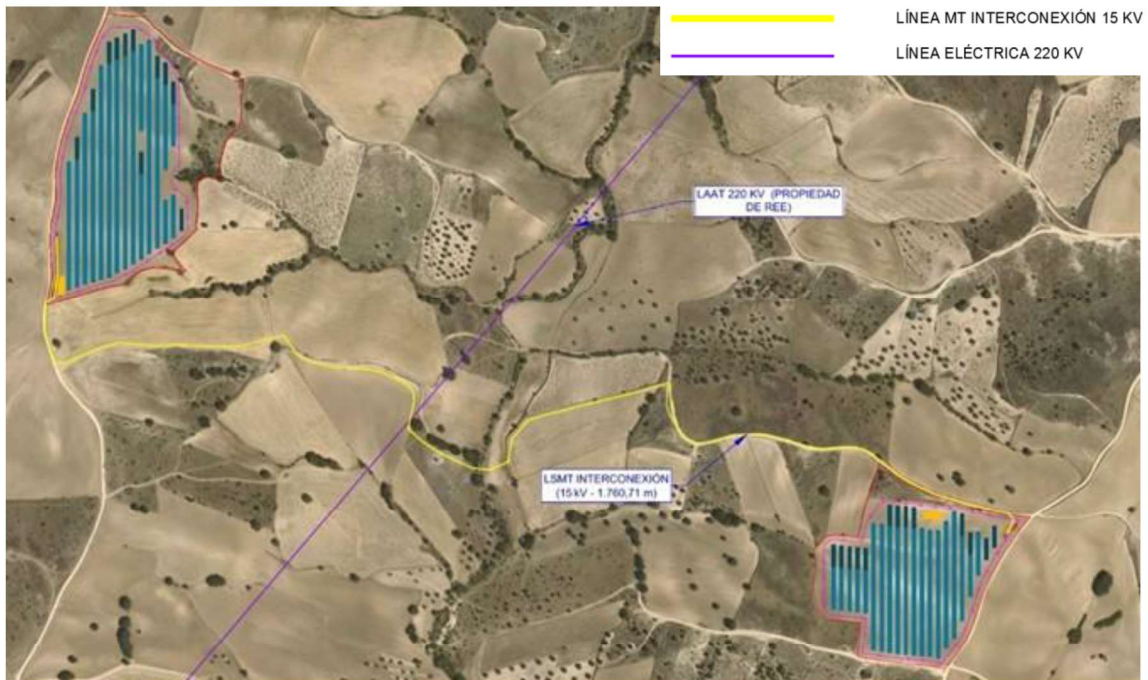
Línea eléctrica aérea existente. Afección a islas de la Planta
